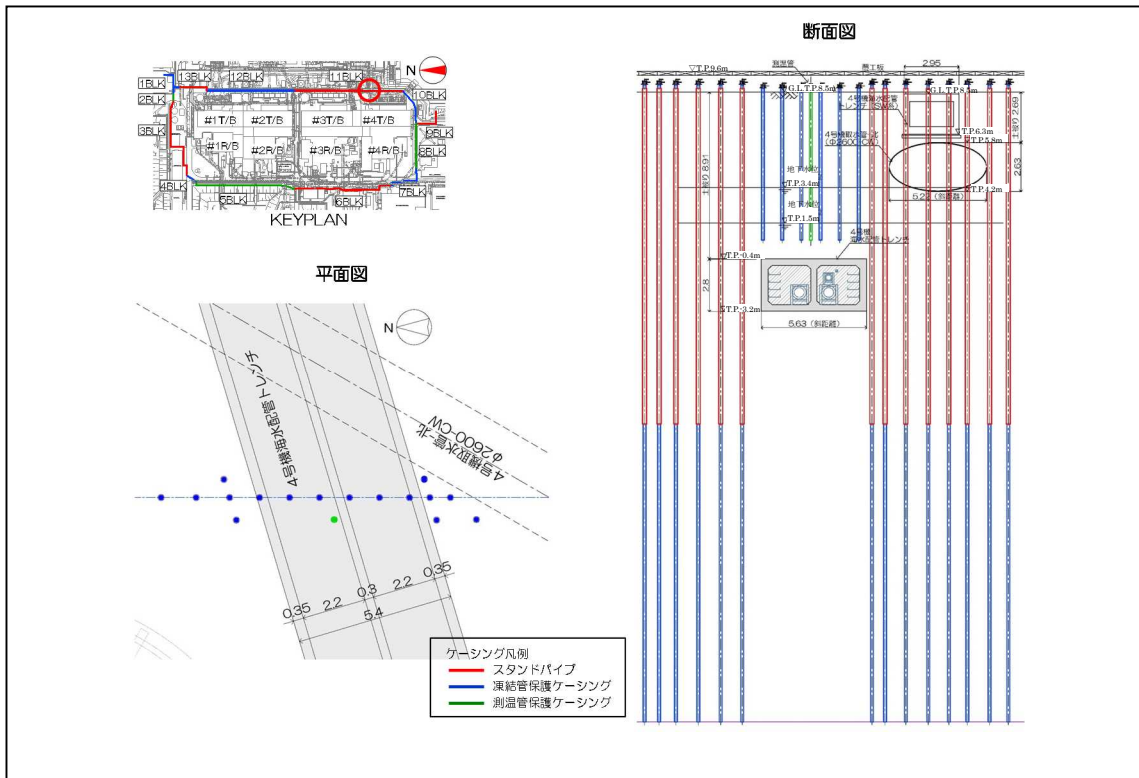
4号機海水配管トレンチ部 施工平面図・断面図
